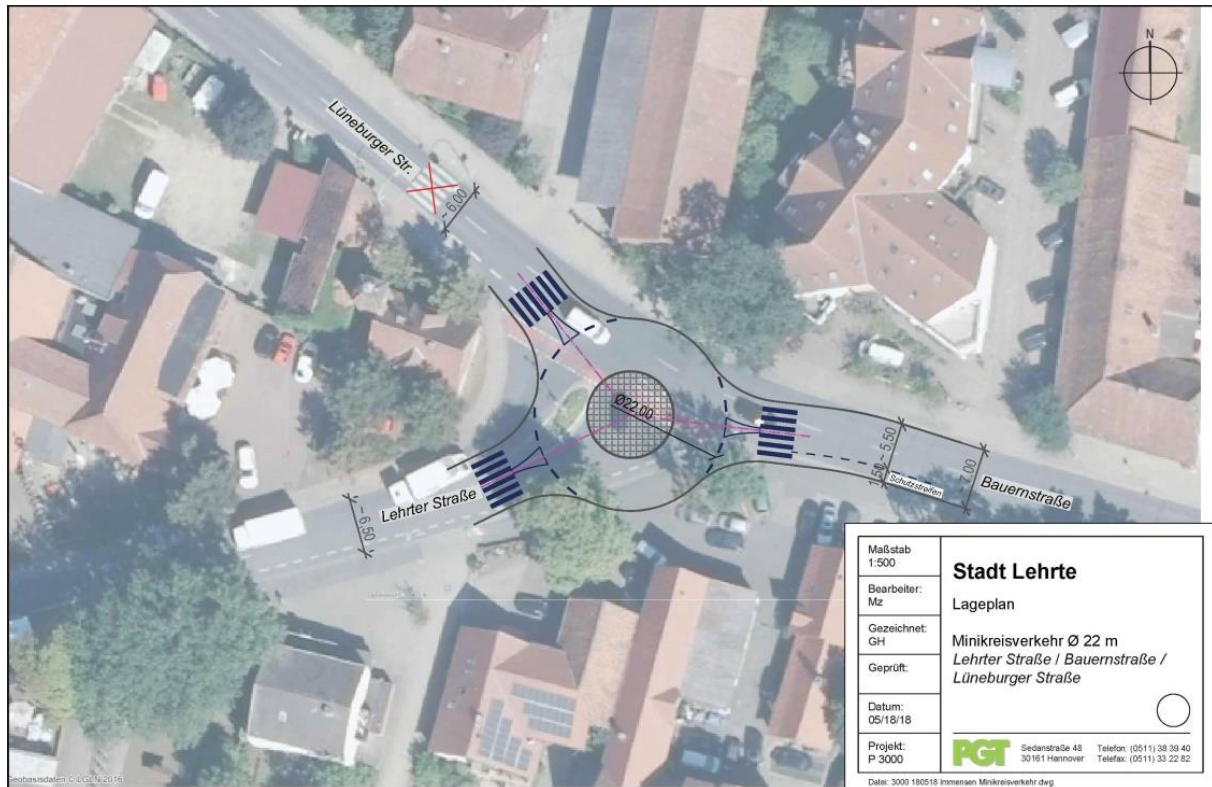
Beispielhafter Entwurf des Knotenpunkts Lehrter Straße / Bauernstraße / Lüneburger Straße
